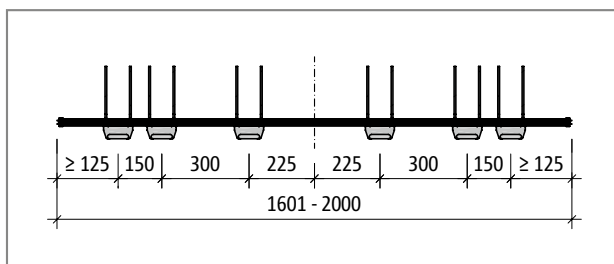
Schöck Tronsole® Typ T-V6-H...-L1601 bis L2000: Produktgrundriss
